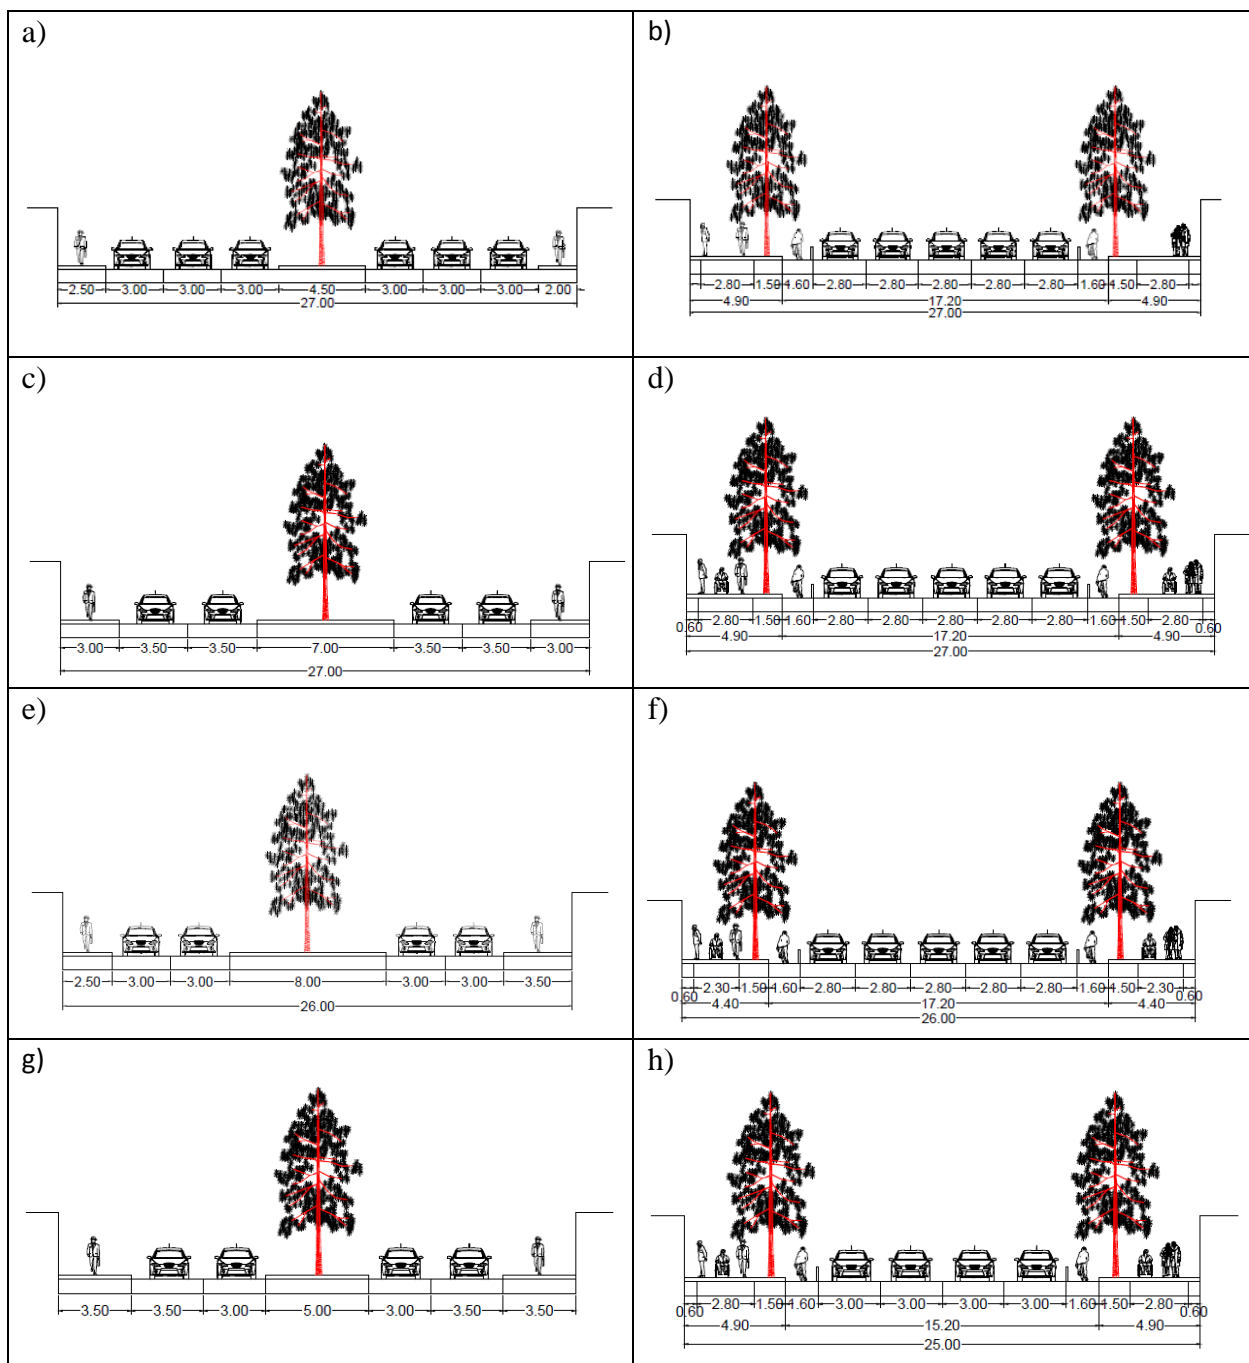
a) corte transversal de um exemplo de projeto alternativo com faixa exclusiva para ônibus. b) corte transversal de um exemplo de projeto alternativo com faixa exclusiva para ônibus, mantendo a arborização no canteiro central
